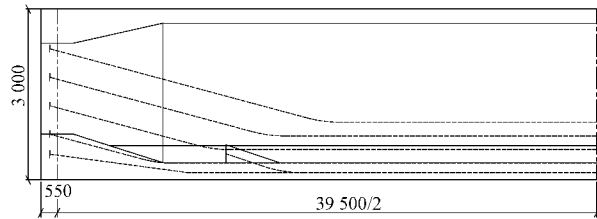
跨度 40 m 简支梁立面布置(单位:mm)
